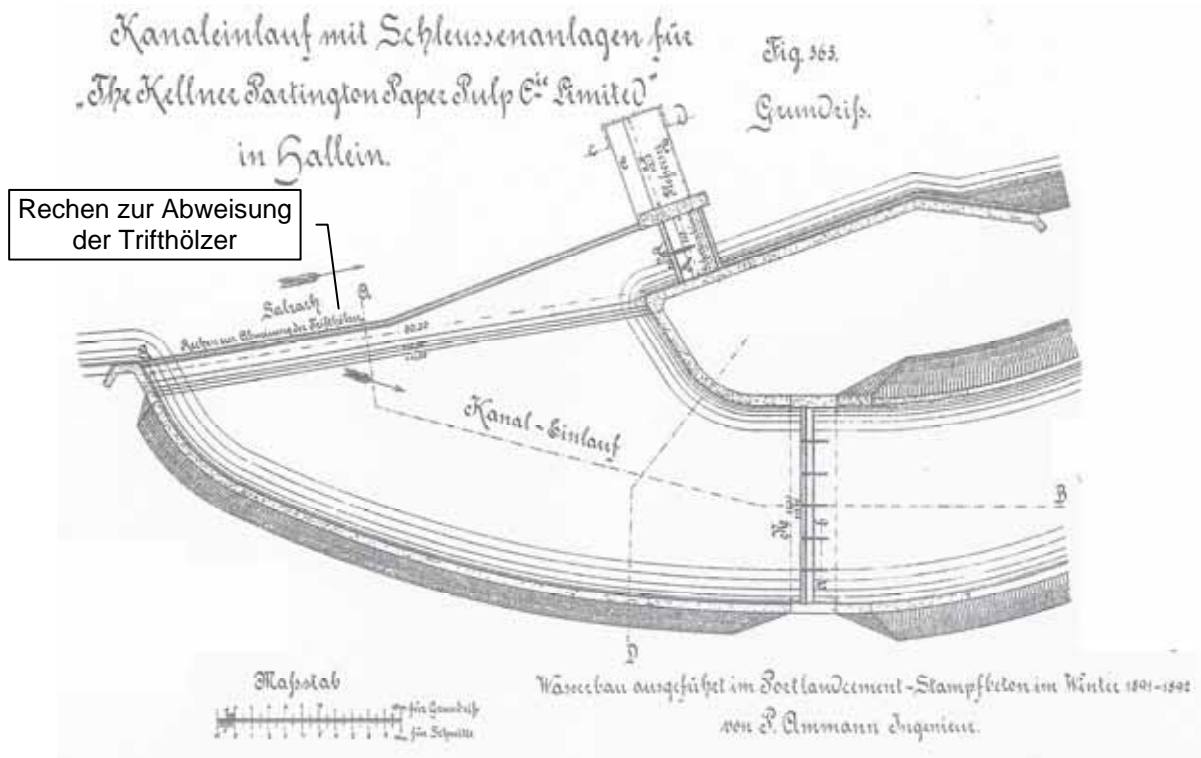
Kraftwerk Hallein, Ausschnitt aus Bild 1: Grobrechen [1]
